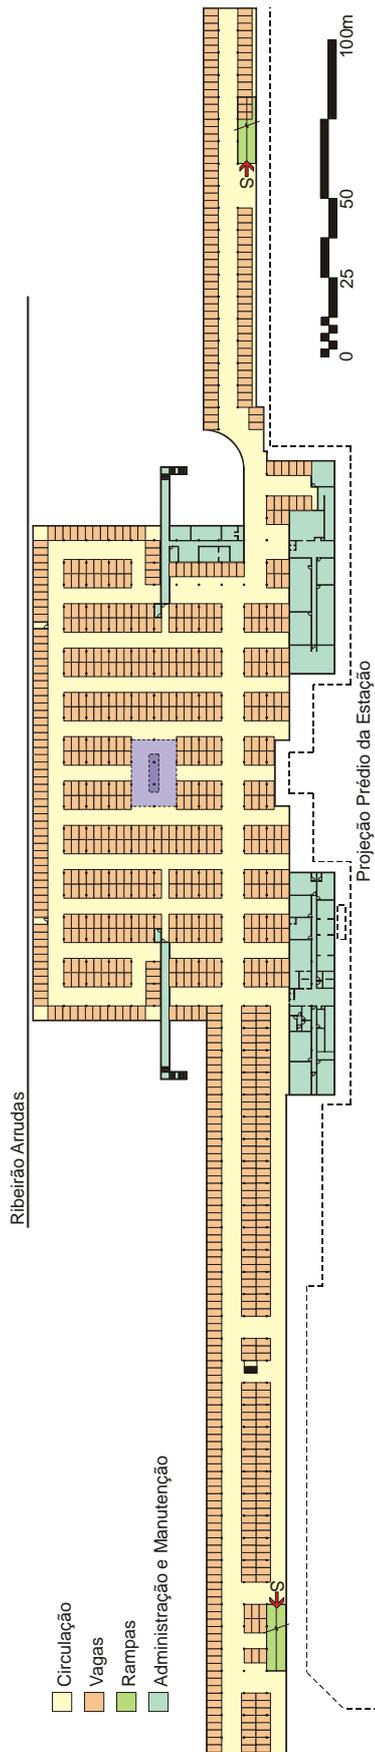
Planta Garagem Subterrânea para a Praça da Estação
